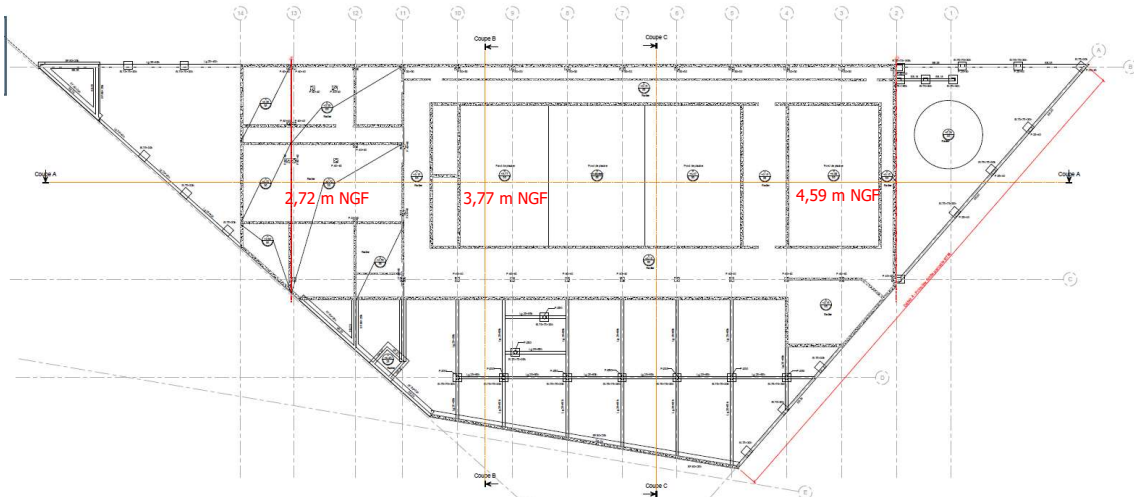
Plan des fondations (source : LAMOUREUX RICCIOTTI - 1201 - Décembre 2024)
